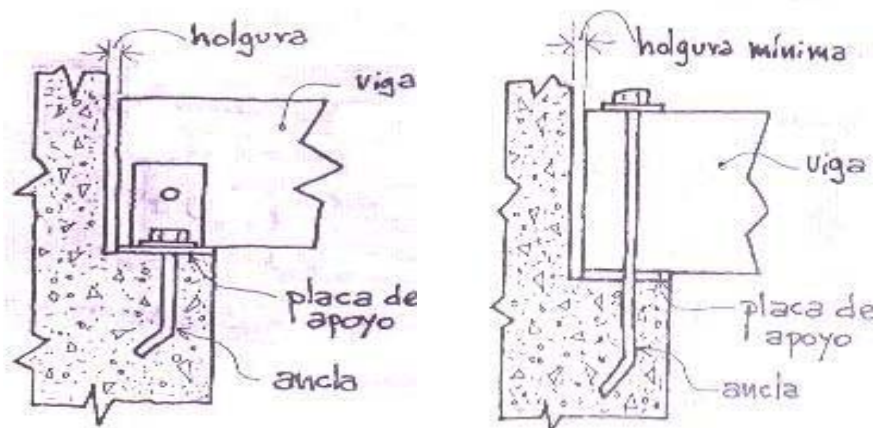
Vigas macizas apoyadas y sujetas sobre concreto.
